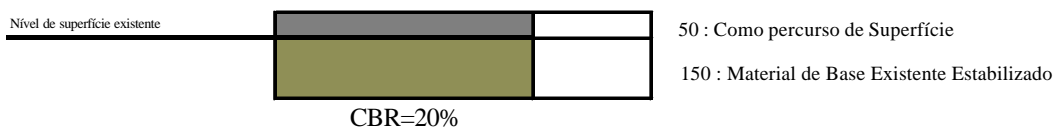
Estruturas de Pavimento Propostas (1)
